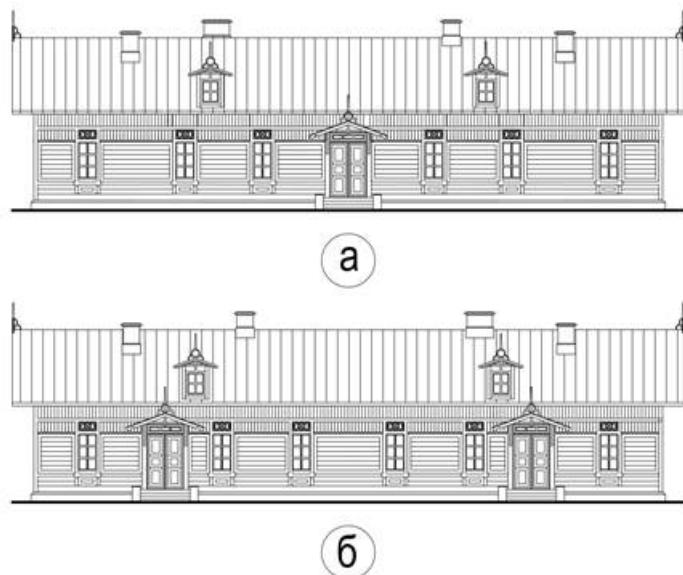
Фасады дома начальника депо: а) главный фасад, ориентированный на улицу Вокзальную; б) фасад, ориентированный на железнодорожные пути (реконструкция автора по фотографии)
